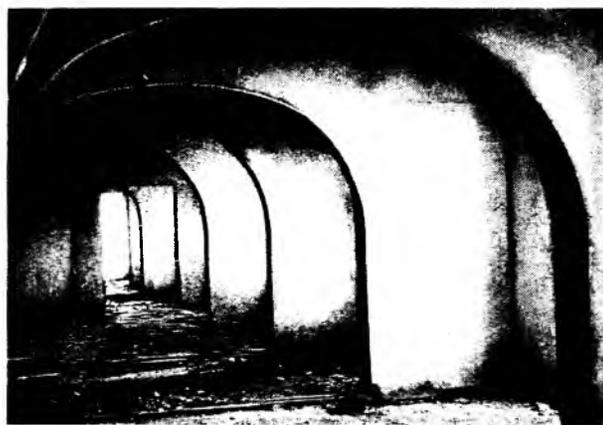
Арочные конструкции первых нежилых этажей 9-этажного дома в г. Твери
